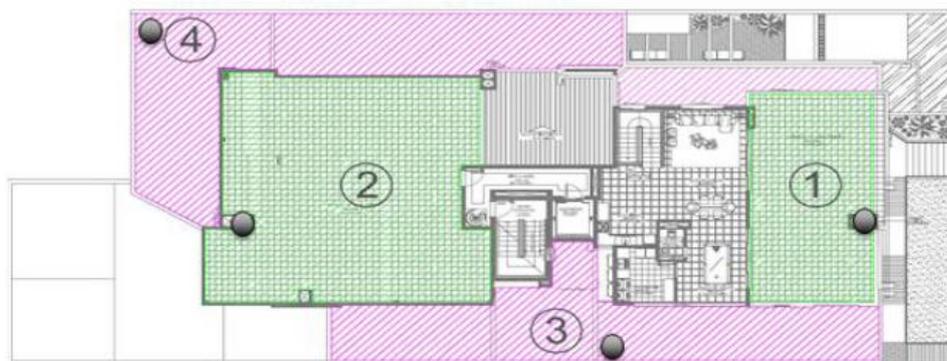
Pontos de captação da água da chuva, 1 e 2 cobertura (12º pavimento) 3 e 4 terraço (4º pavimento).
